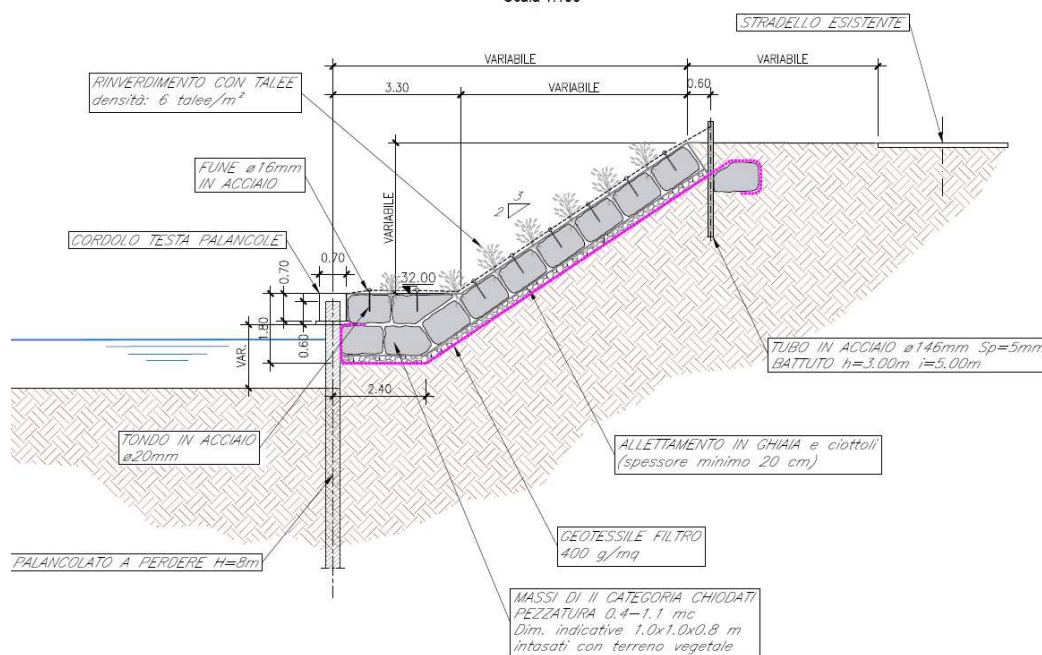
“Sezione della sistemazione di progetto sulla sponda destra”
